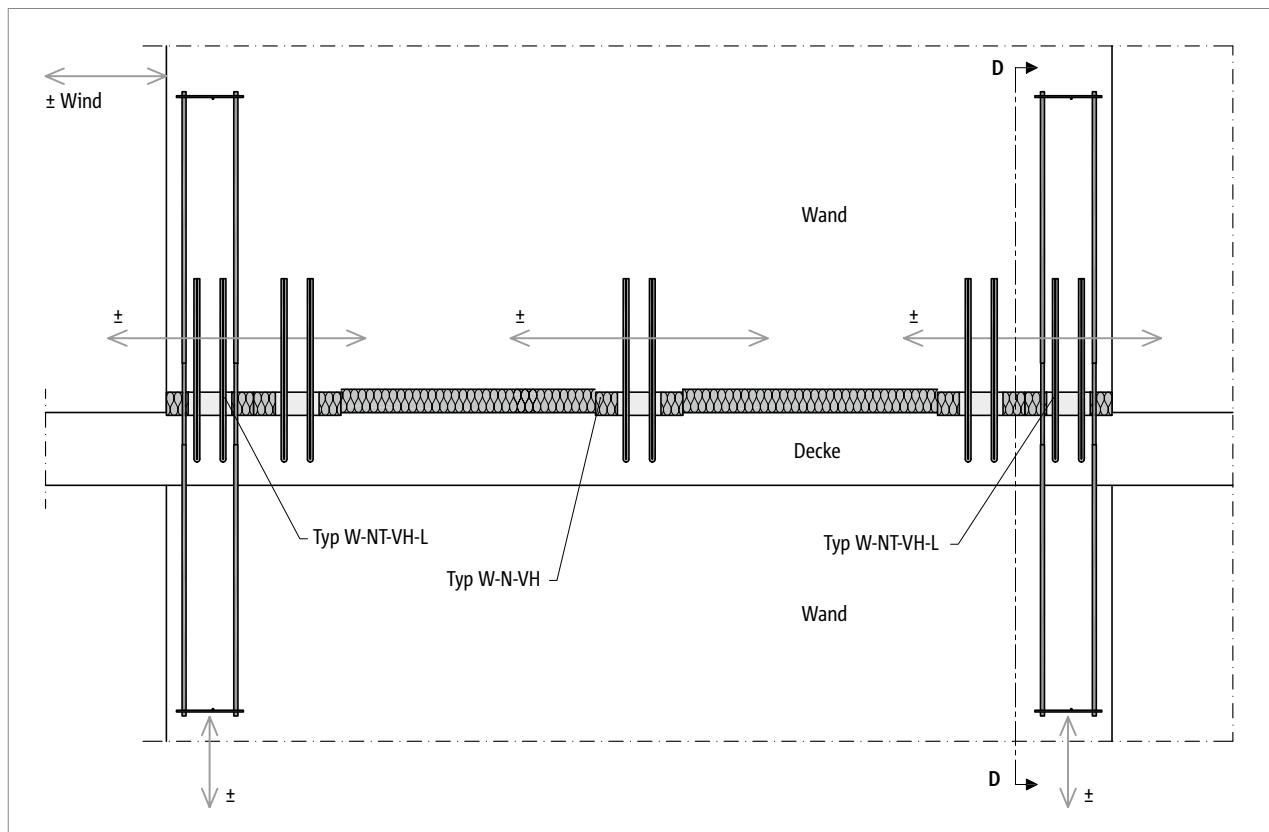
Schöck Sconnex® Typ W: Kombinierte Produktvarianten für den Anschluss einer horizontal belasteten, stabilisierenden Wand
